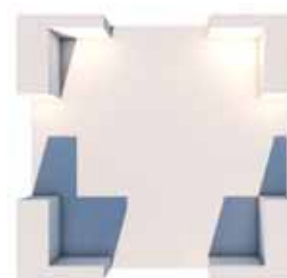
Planta del cenador donde se integran las bancas en su composición.
